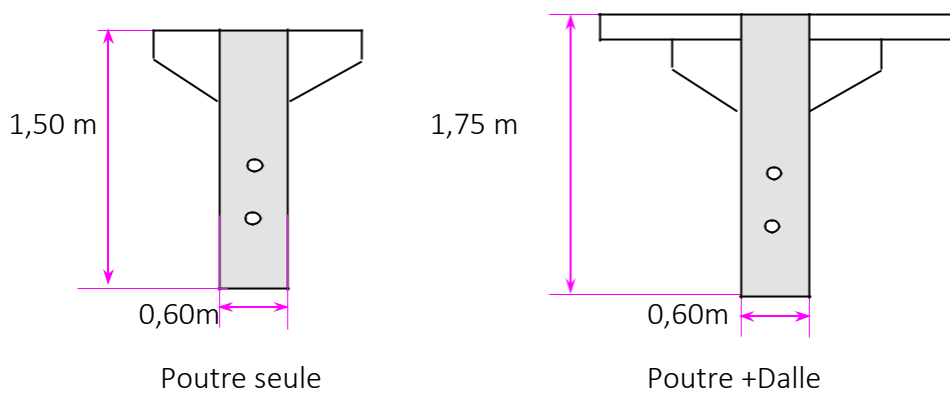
les sections résistante dans les (Poutre seule et Poutre +Dalle).
